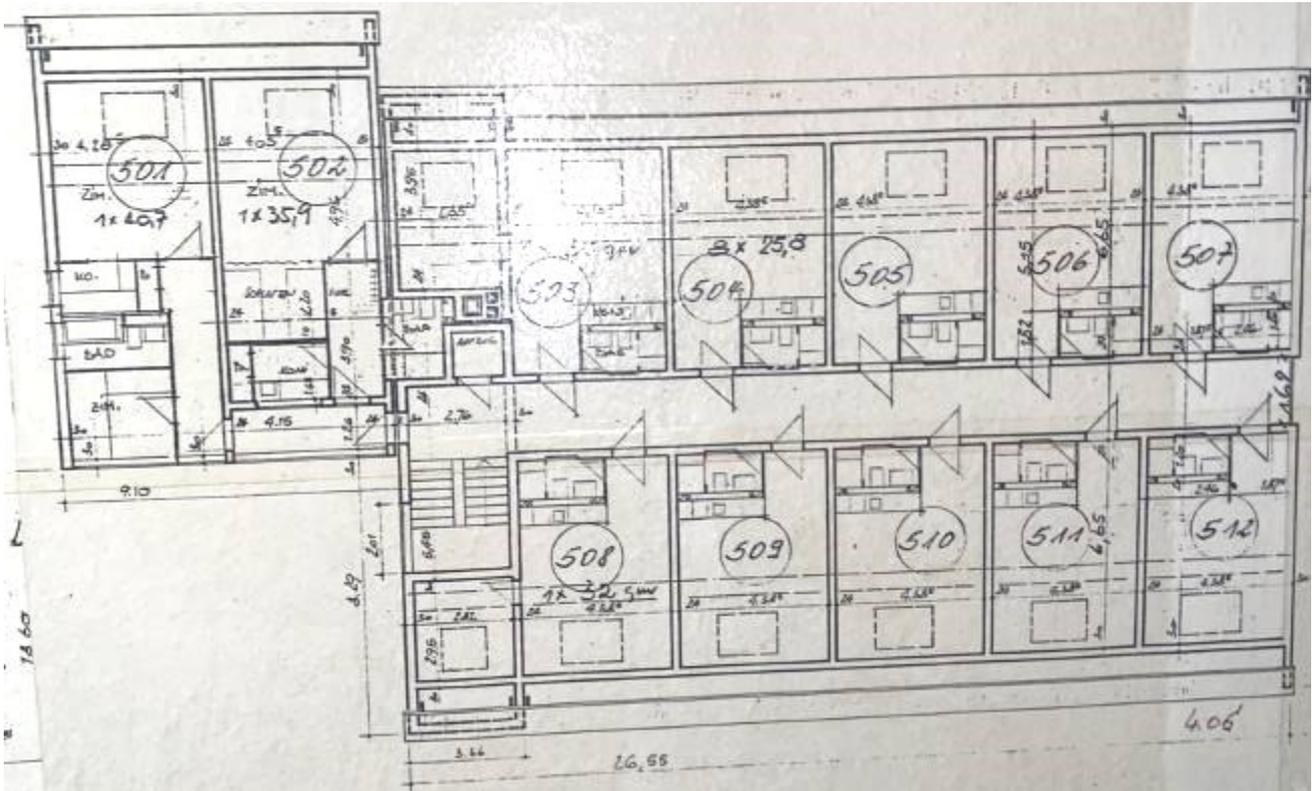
Foto des SV; Grundriss Dachgeschoss 1. Ebene; Quelle: Montageplan Heizung
